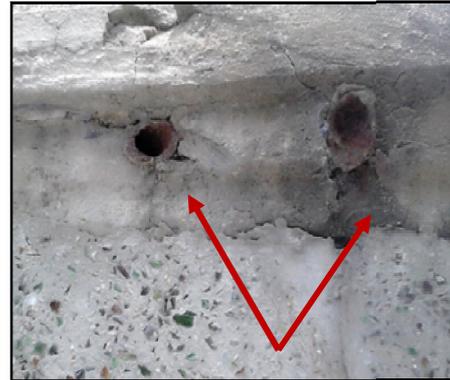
Detalhe dos furos para a colocação dos andaimos na fachada sudoeste e o desprendimento da argamassa.
